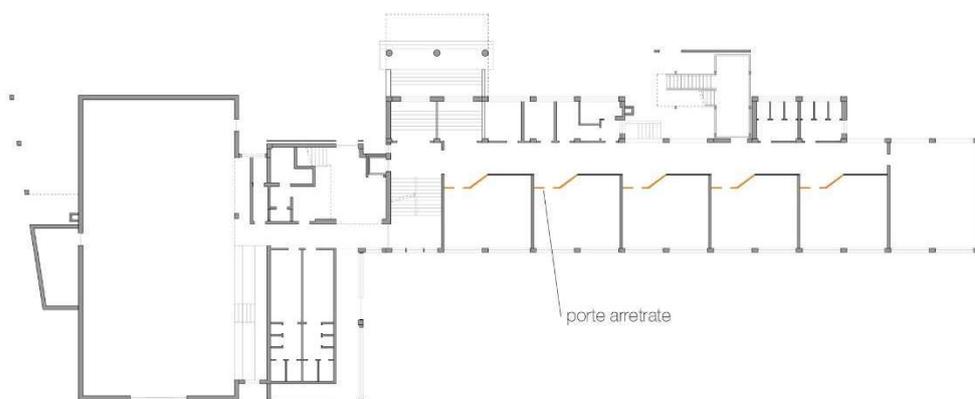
schematizzazione dell'intervento di arretramento delle porte delle aule in entrambi i piani.
